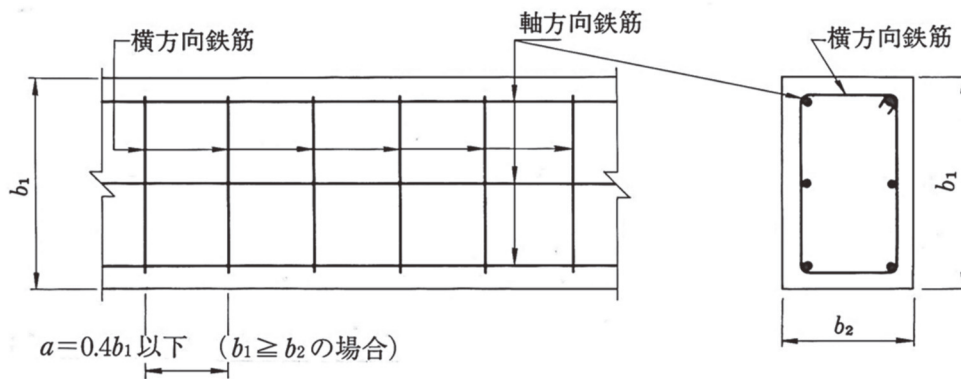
ねじりモーメントに対する鉄筋の配置
